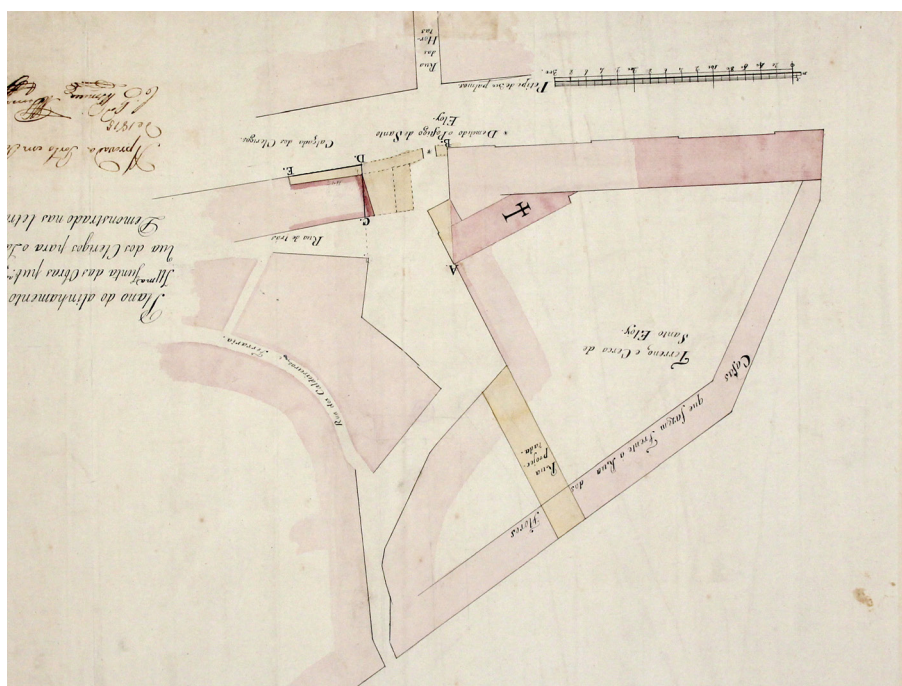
Plano de abertura da Rua D. Maria II. Aprov. Junta de Obras Públicas, 1815.
